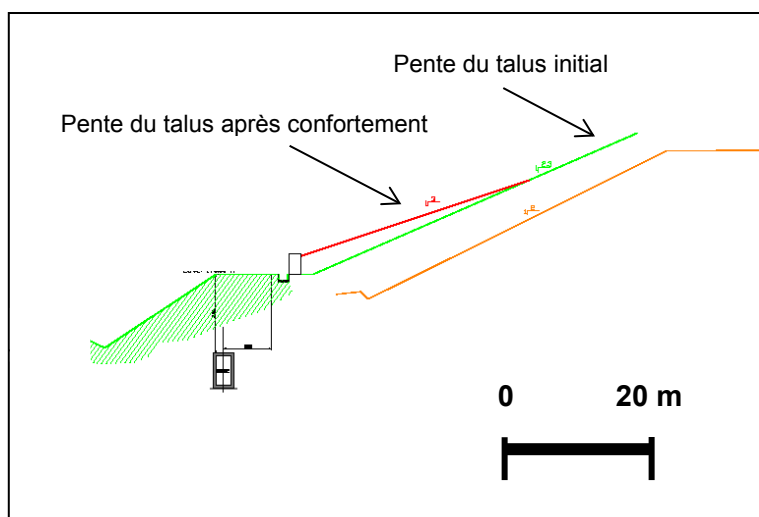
Confortement des pentes légèrement instables (Andra, 2008 b).
